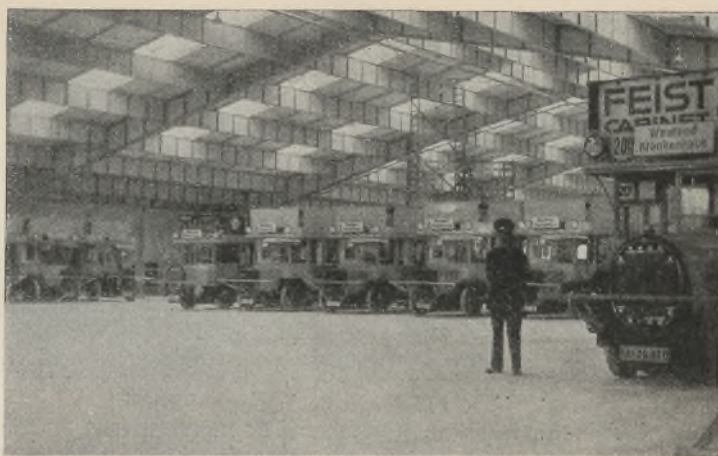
Aboag-Wagenhalle in der Morsestraße, Berlin. (Ausführung A. Druckenmüller, Berlin. Entwurf Baurat Ahrends.)
